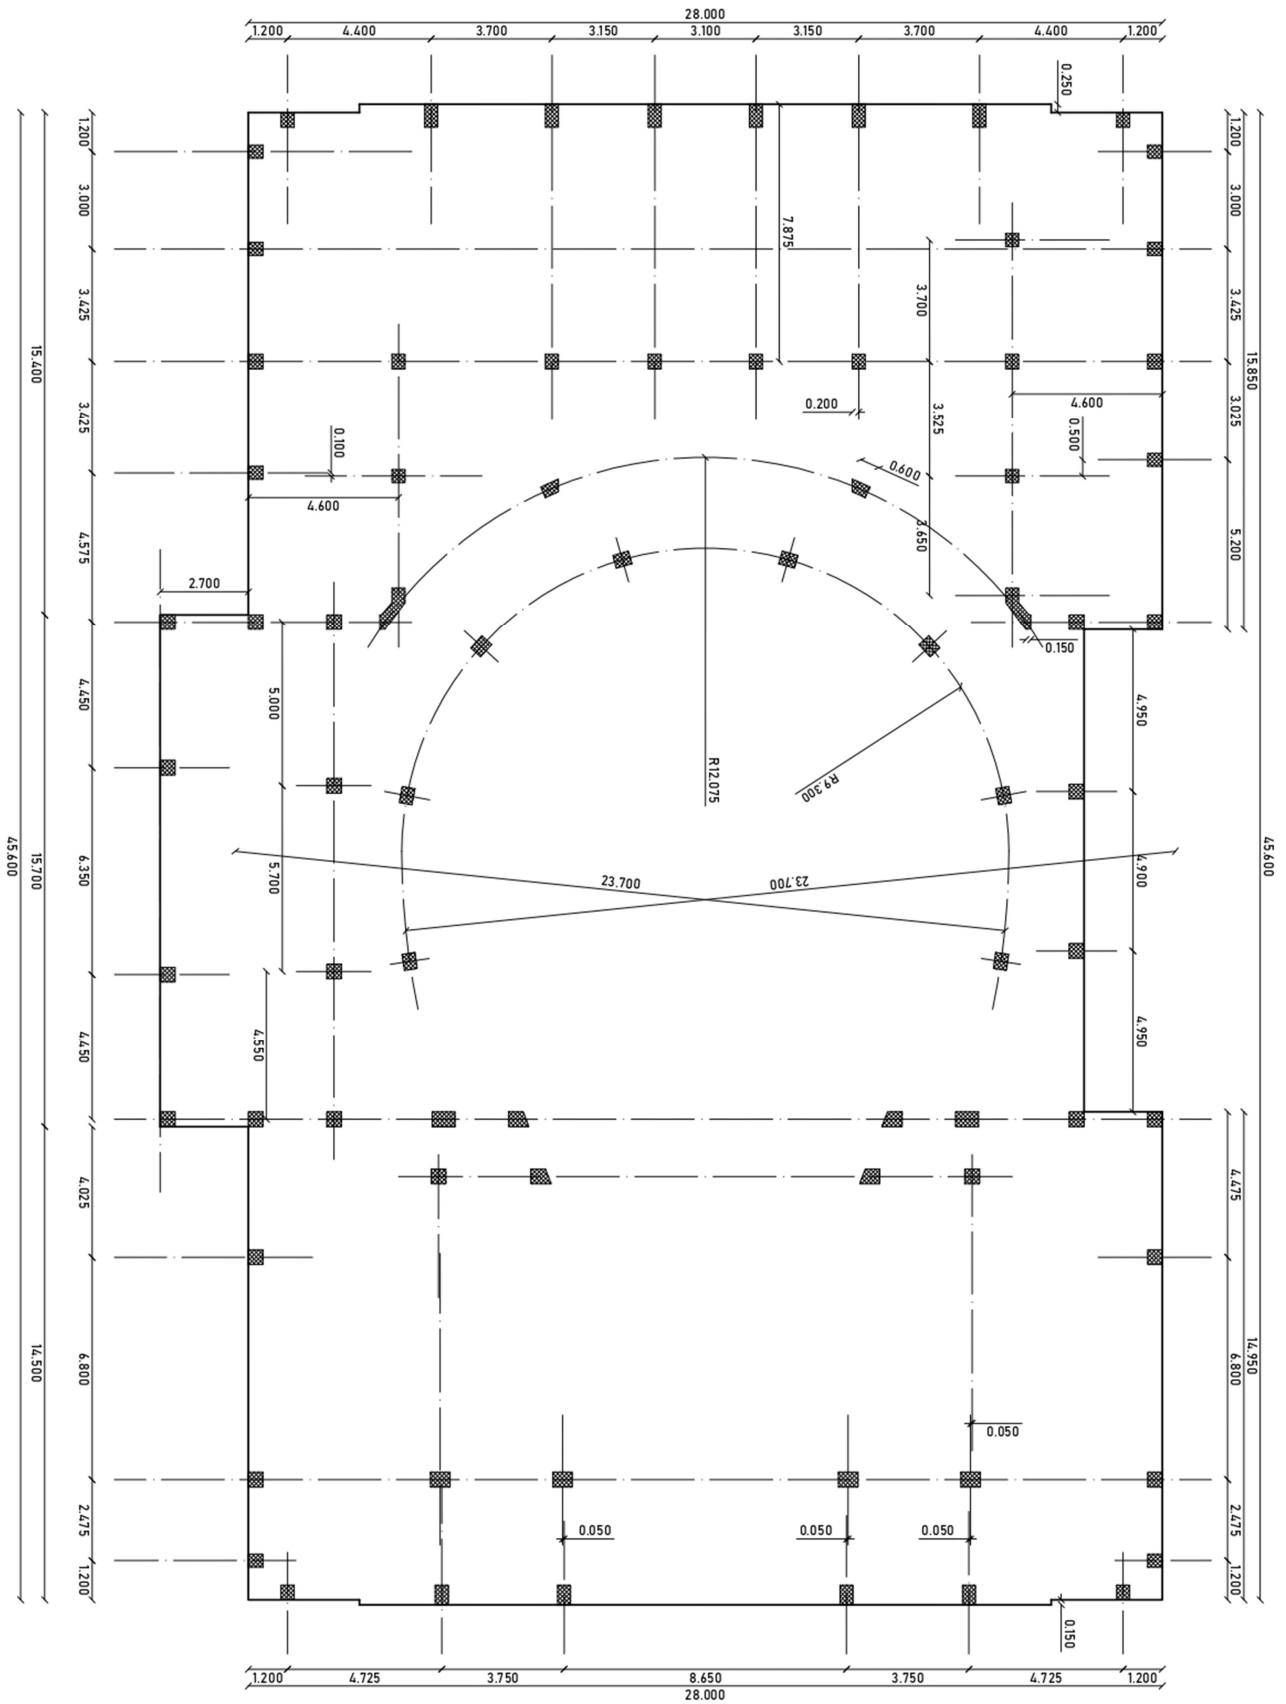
Pianta pilastri piano platea su sotterraneo
